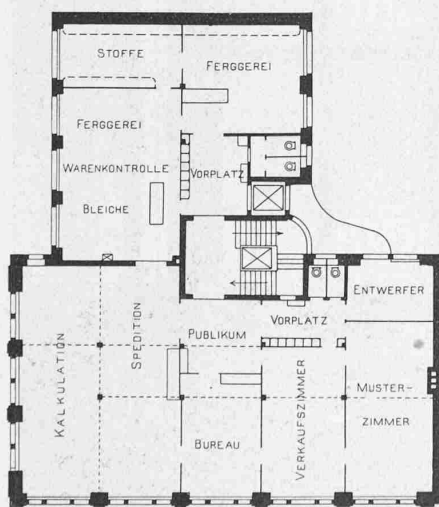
Grundriss vom zweiten Obergeschoss.
